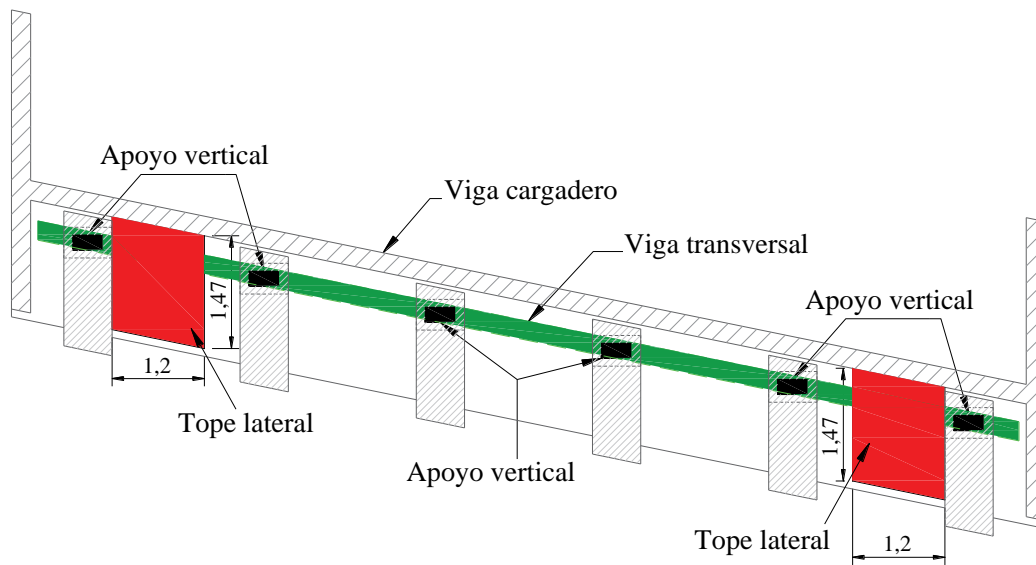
Vista esquemática superior del apoyo del puente de calle Paso en uno de los estribos.
